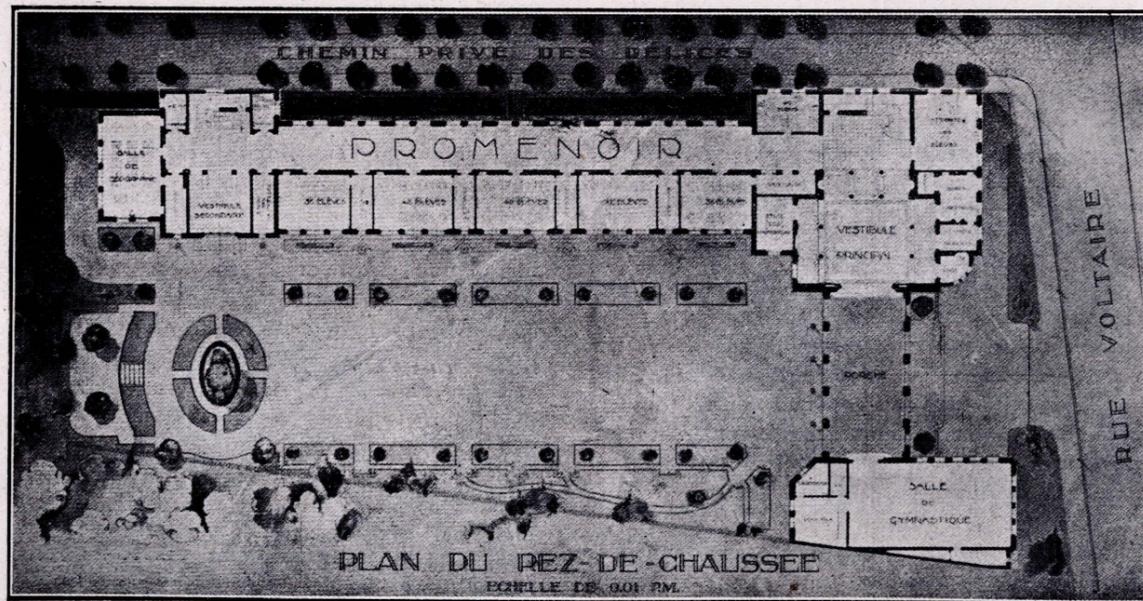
Nuova Scuola per fanciulle a Ginevra. Pianta del pianterreno.
